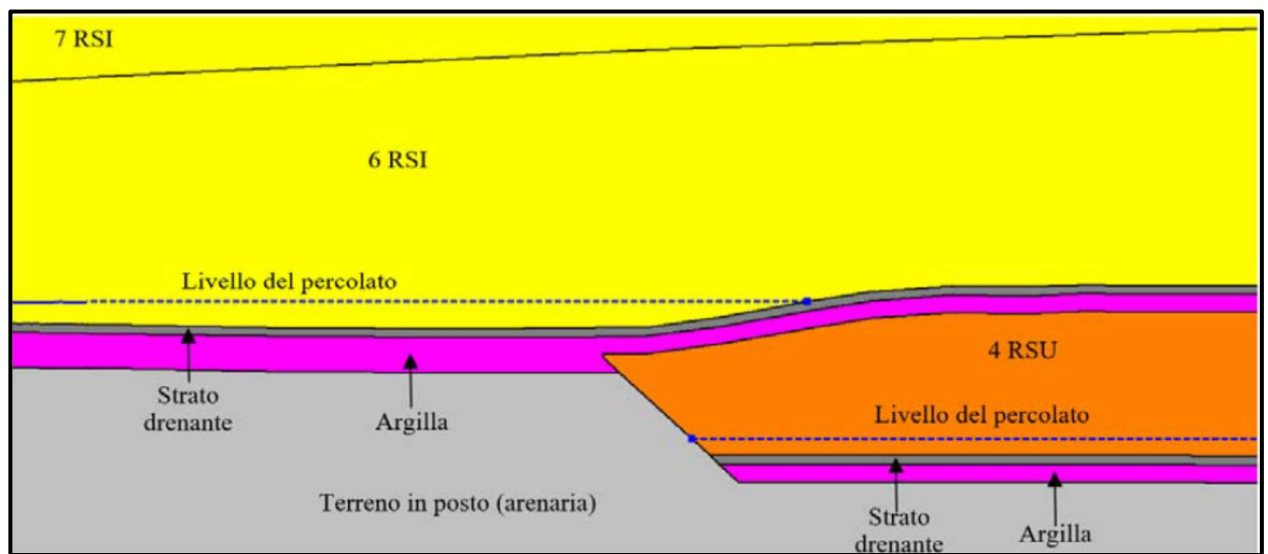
/III – Sezione A-A' – Sponda nord-est - Particolare 2
